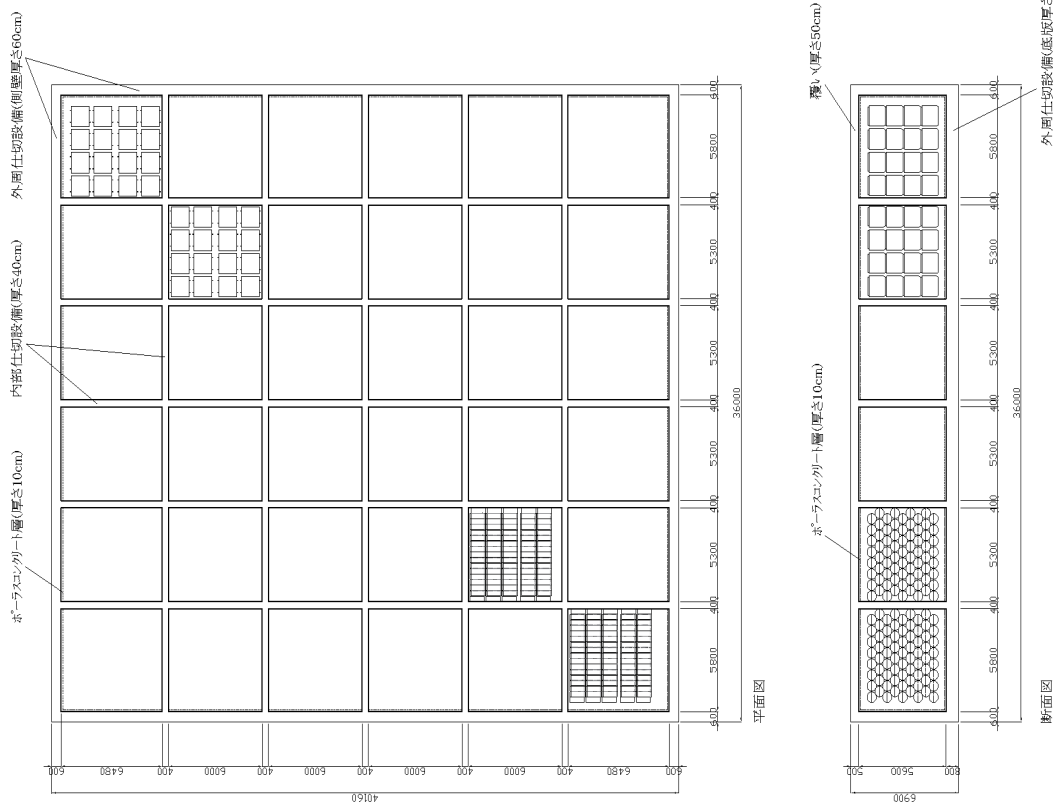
コンクリートピット埋設施設の形状(平面図、断面図)
